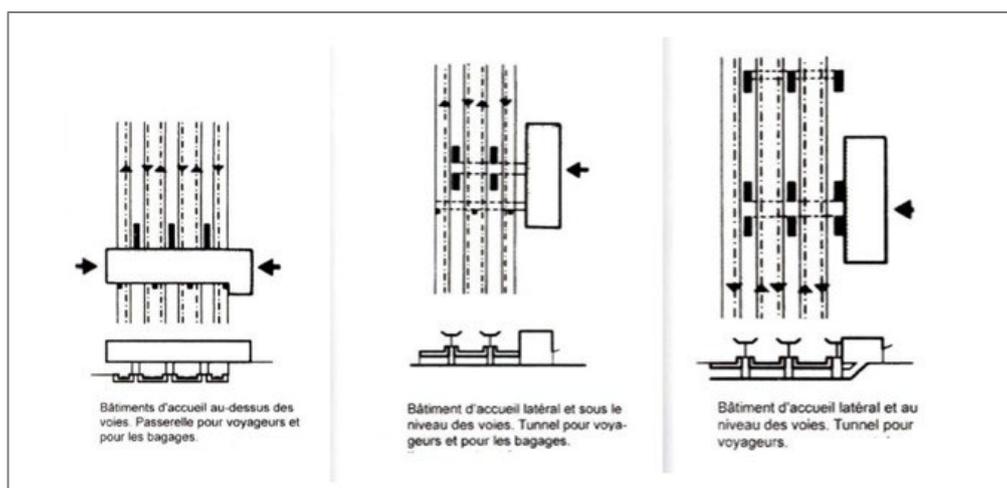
Disposition du bâtiment de la gare par rapport aux voies ferrées.
